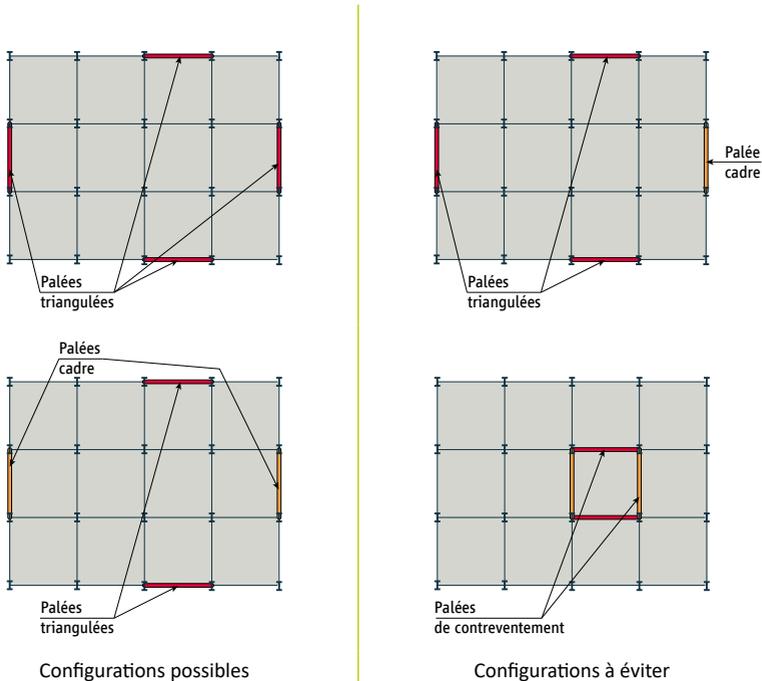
Exemples de configurations de contreventement (trames en plan)
